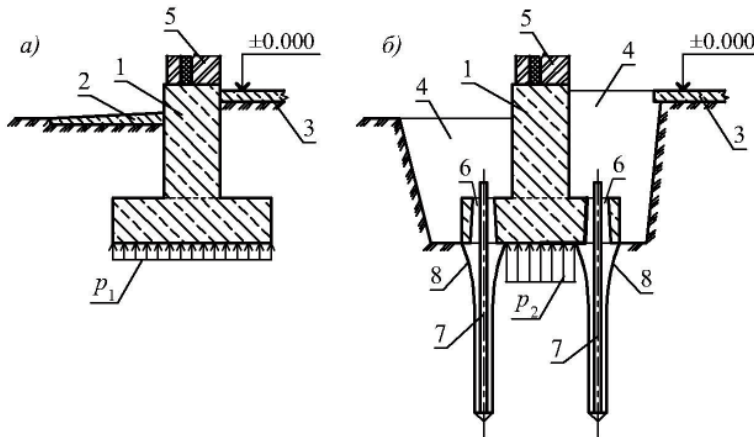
Уменьшение площади опирания фундамента мелкого заложения при устройстве скважин под инъекционные сваи непосредственно под его подошвой: а – схема работы фундамента до его усиления;
